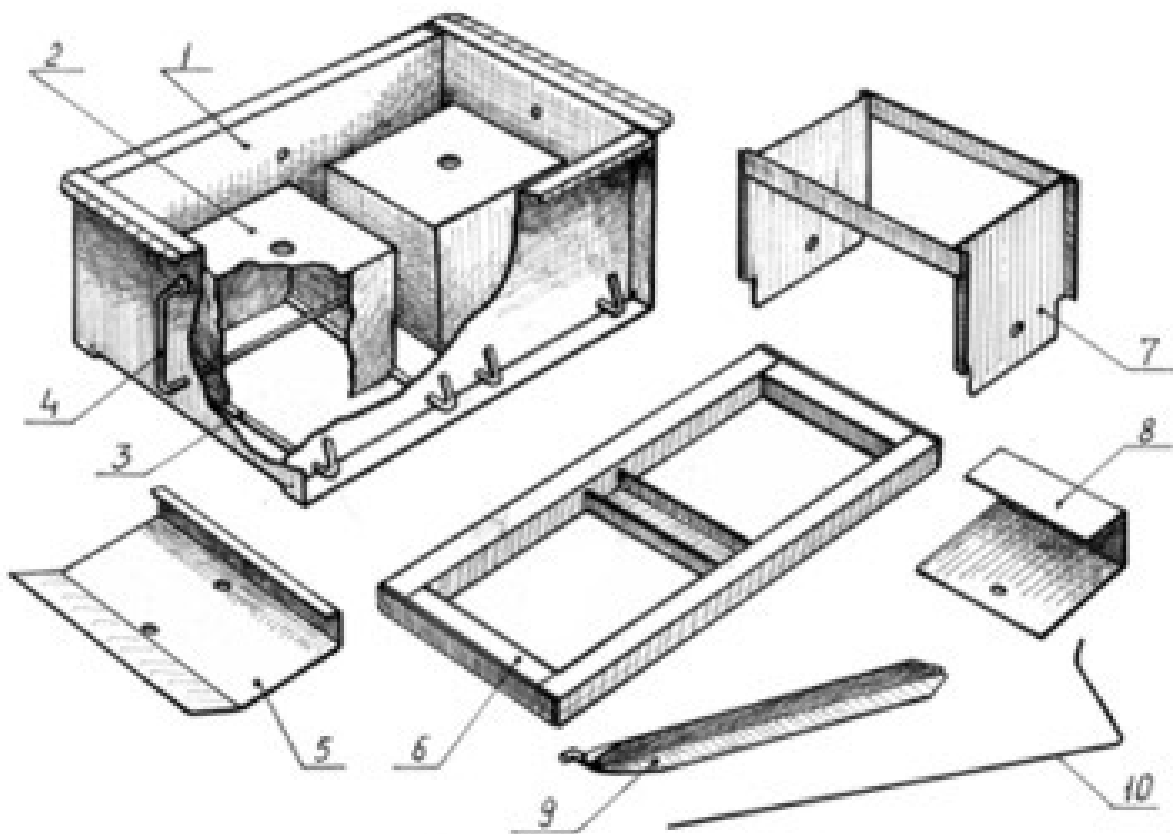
Деталі модуля ТІБЕ: 1 - форма; 2 - пустотоутворювач; 3 - поперечний штир; 4 - поздовжній штир; 5 - перегородка-скребок; 6 - вижимна панель-трамбування; 7 - опалубка-компенсатор; 8 - скоба; 9 - куточок формувальний; 10 - стопор дротяний
